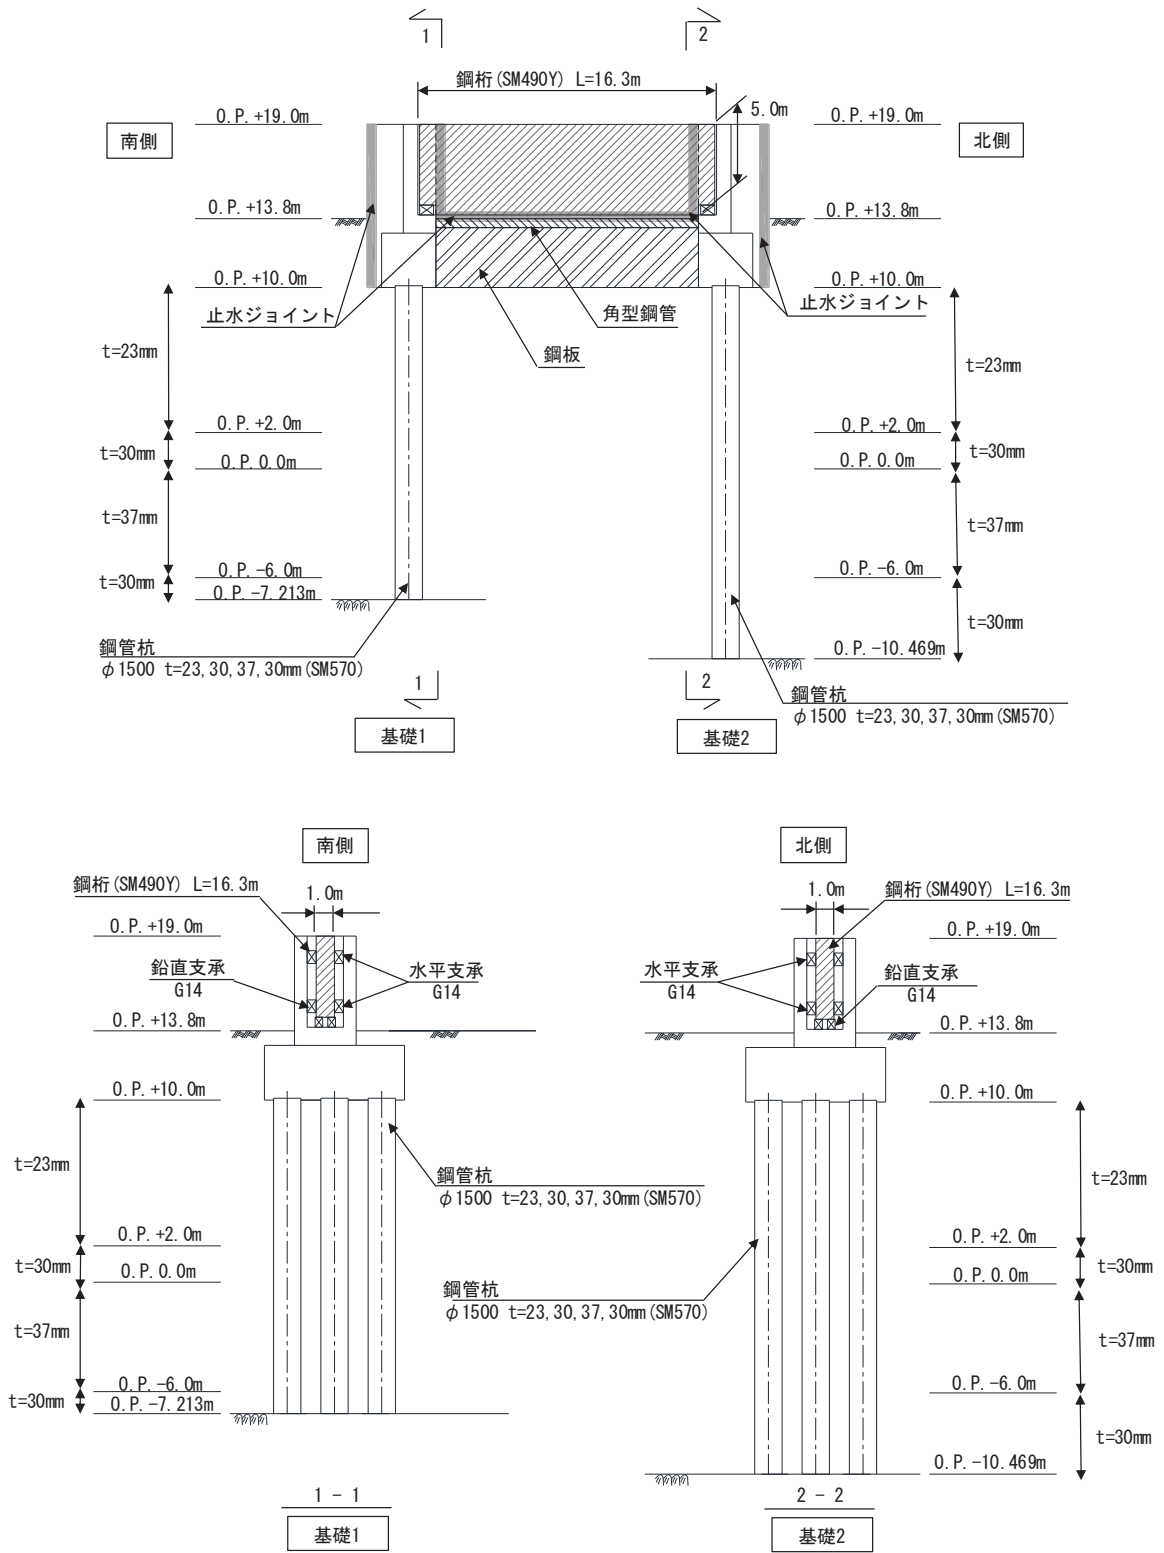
鋼製遮水壁（鋼桁 5） 正面図及び断面図
